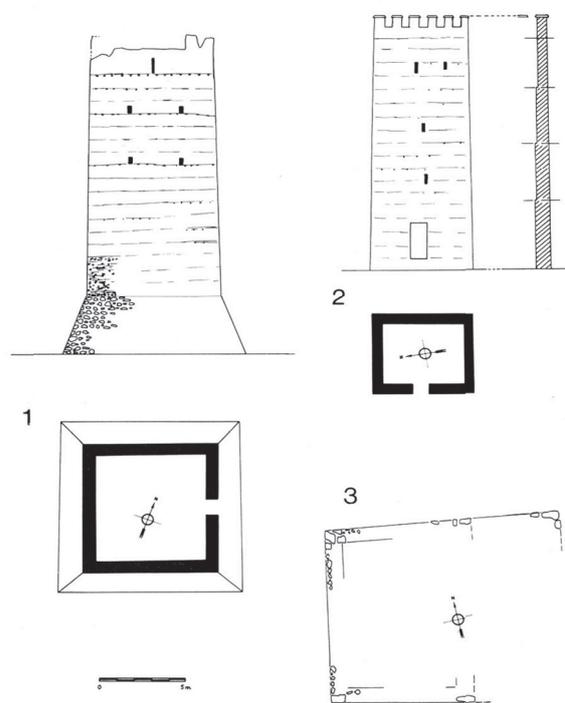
Tours du sud de Valence. — 1. Elévation de la face sud et plan de la tour de Musa. — 2. Elévation de la face ouest, coupe verticale du mur sud montrant les décrochements où s'établissaient les planchers et plan de la tour d'Espioca. — 3. Vestiges au sol de la tour de Trullas.
